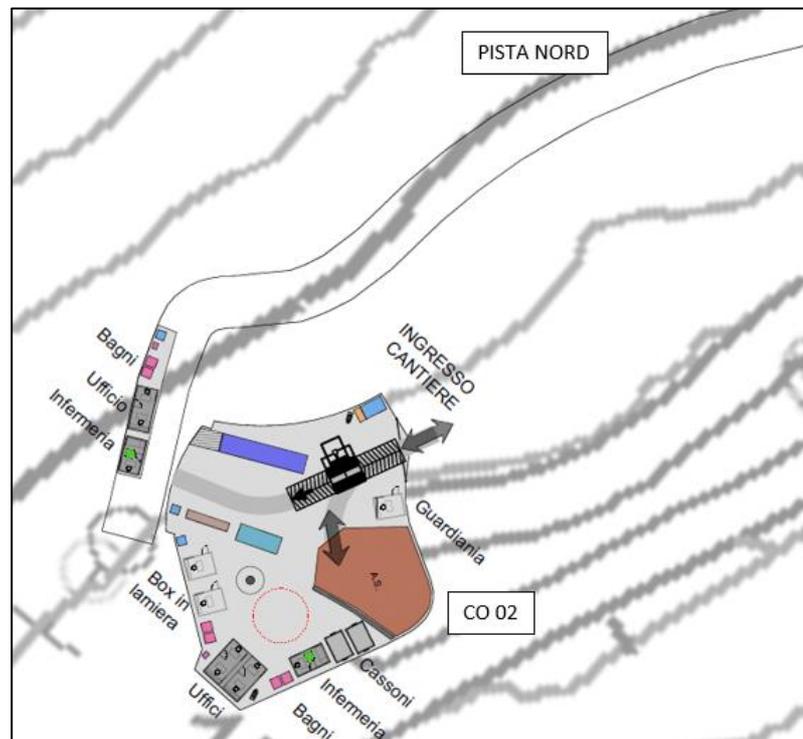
Layout cantiere operativo all'imbocco nord ( Pista nord e CO 02) – (vista ruotata)
